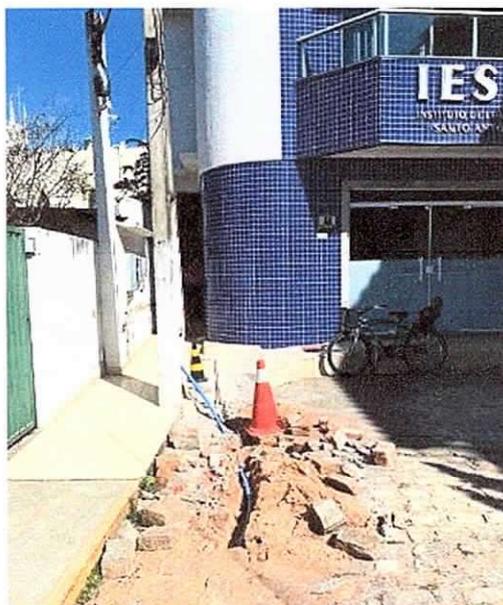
Execução de extensão de rede para instalação de hidrômetro
